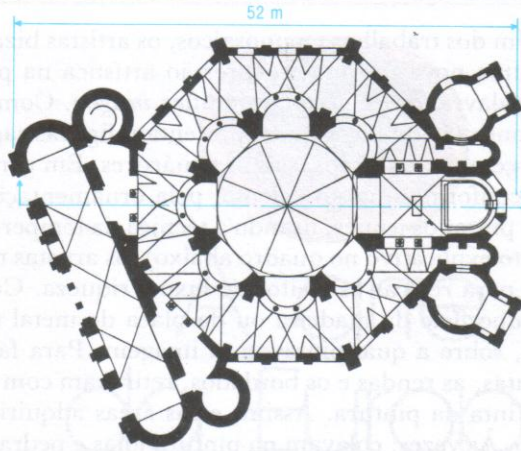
Planta da igreja de São Vital, em Ravena (526-547).
